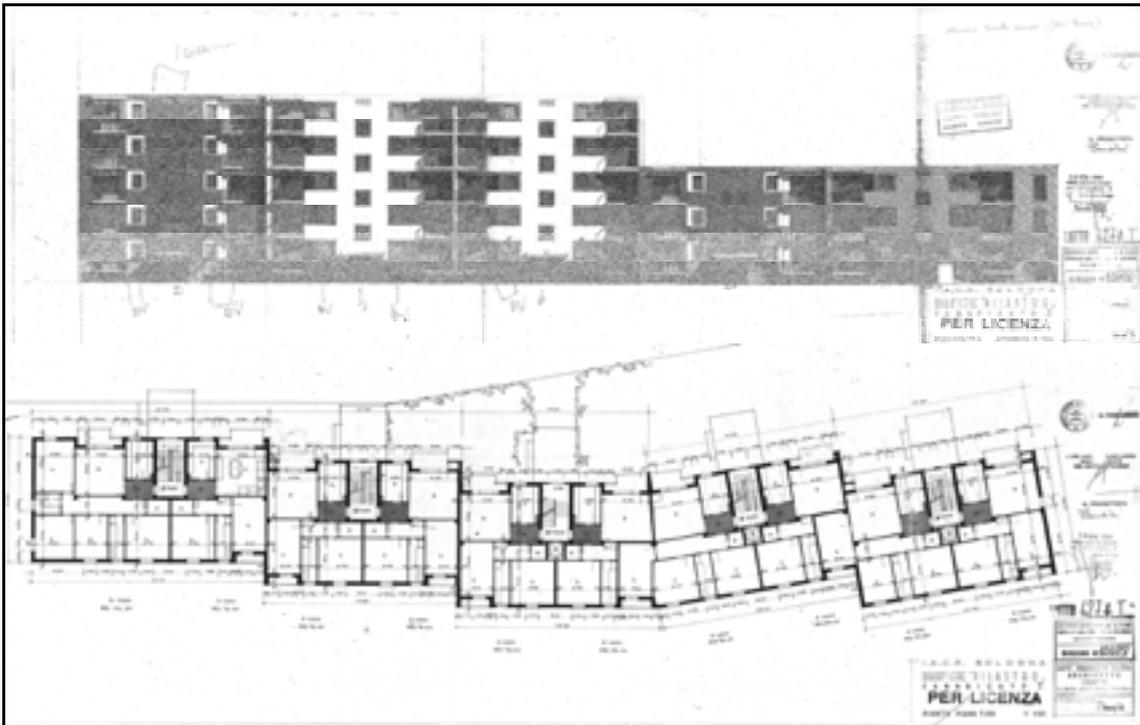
Pianta del piano tipo e prospetto dell'edificio n. 7 lotto 427 T di via G. D'Annunzio. Archivio progetti Acer Bologna.
